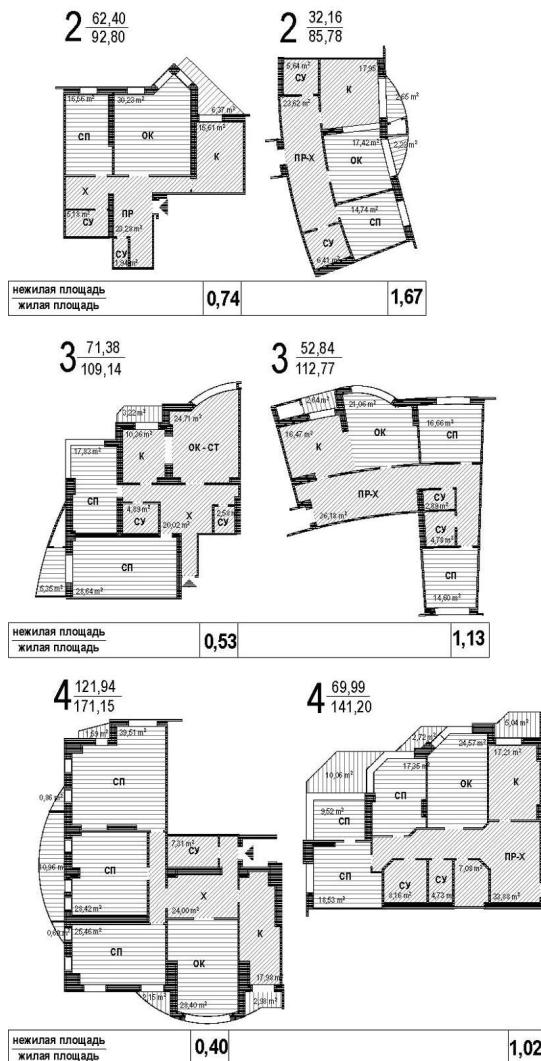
Примеры решения современных квартир и диапазон соотношения нежилой площади к жилой в этих квартирах.
